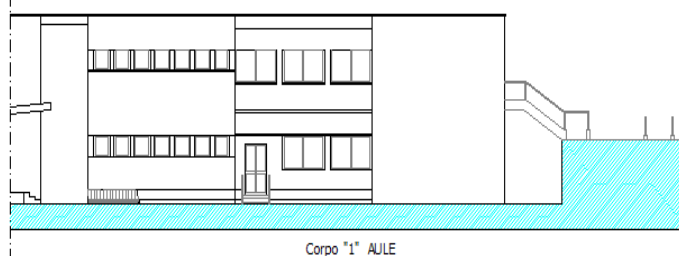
Prospetto est e nord – (disegno fornito dall'ing. A. Giardi)
